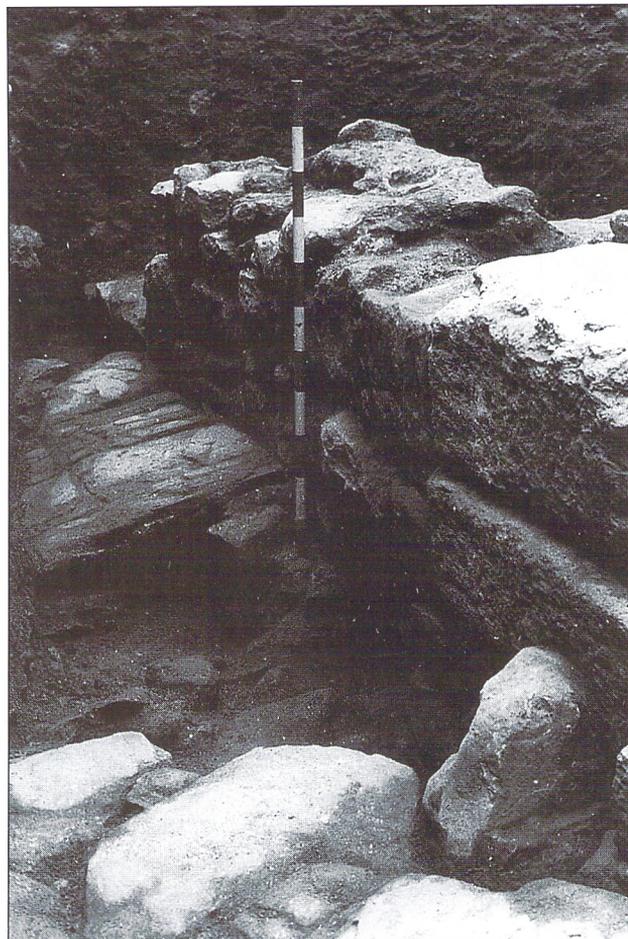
Alzado del muro altoimperial, y parte de la calzada con las losas levantadas, donde se observa un desagüe.
